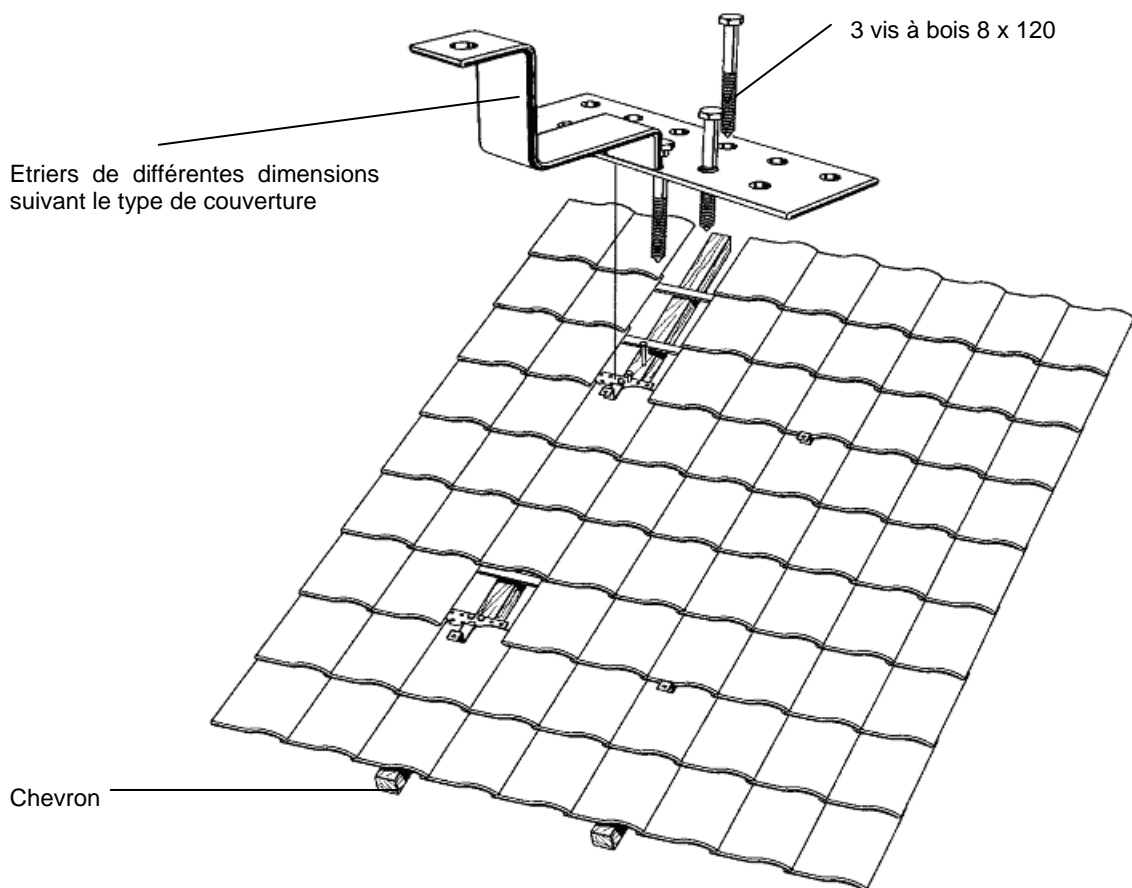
Détail fixation de la latte de support et des pattes d'ancrage
